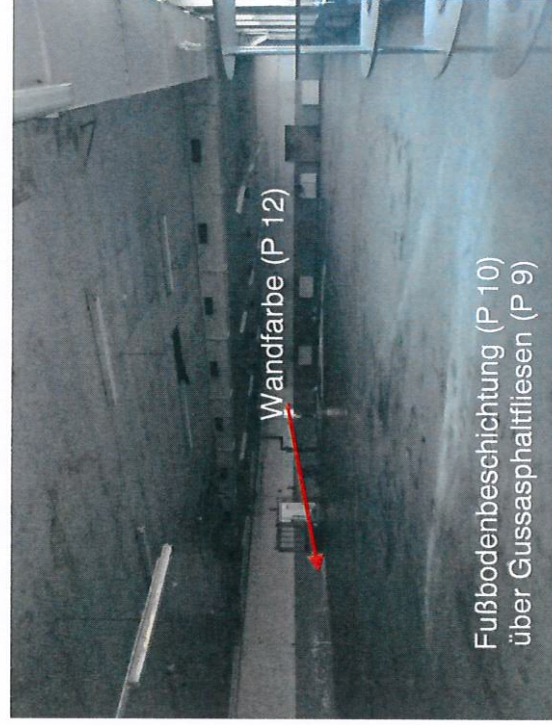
Warenschau/Verpackung mit KMF-Abhangdecke
